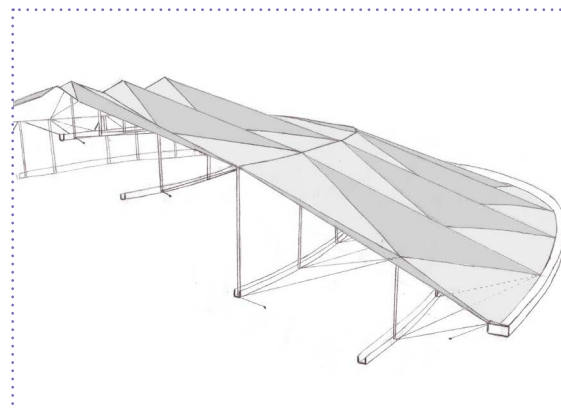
Aspecto exterior de la cubierta del estadio Georgia dome
